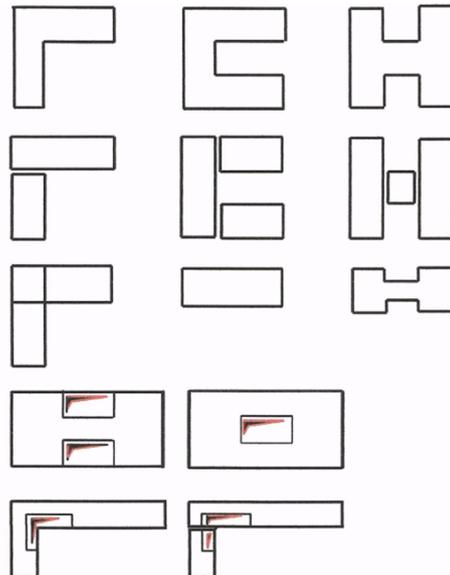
Примеры нерегулярных зданий в плане (вверху) и их согласование (ниже)
